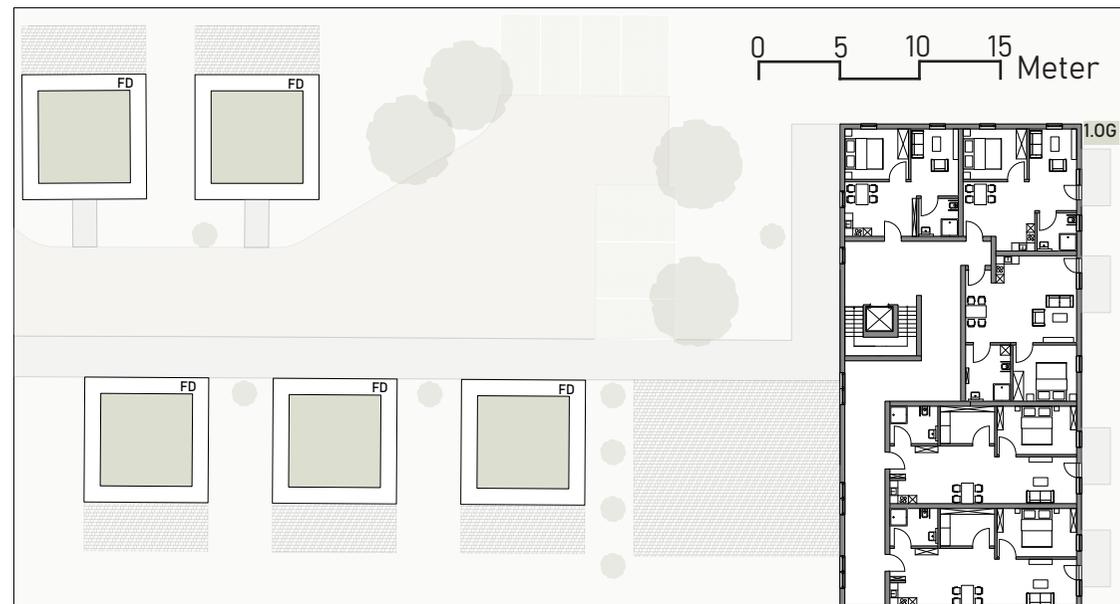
Grundriss 1. OG (V2 Mischbauweise)
